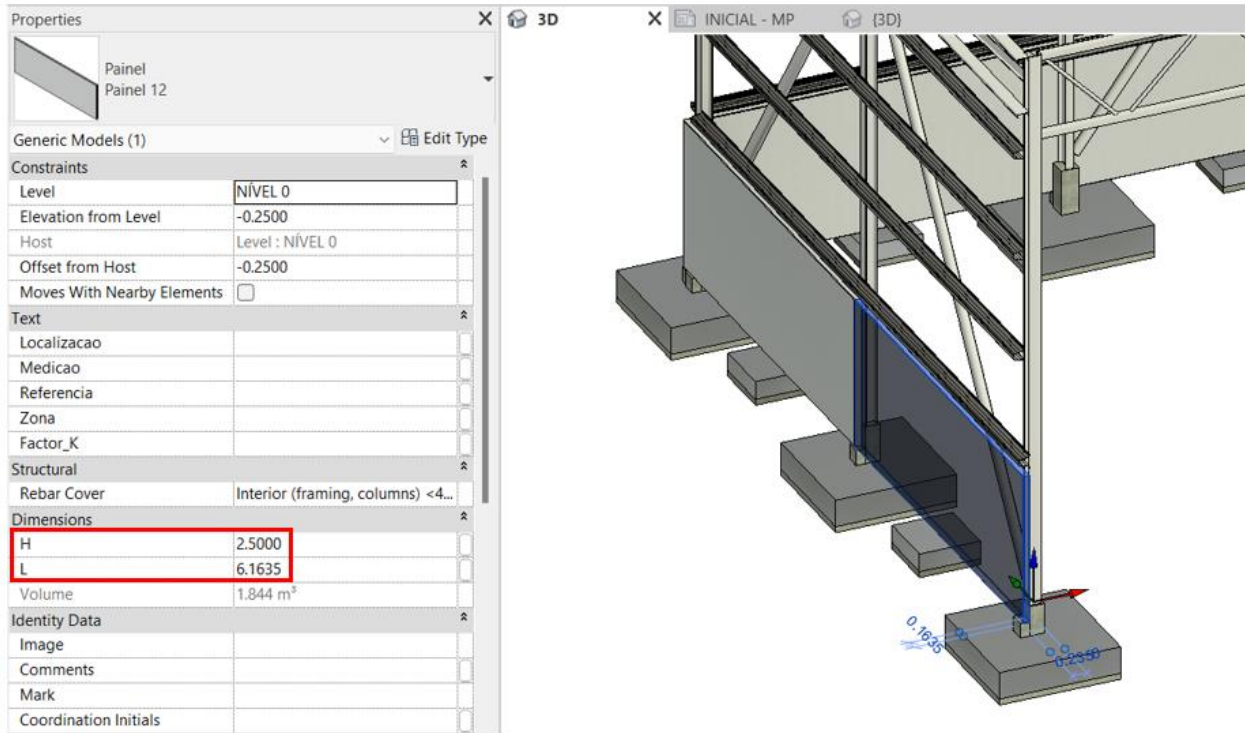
Parâmetros do painel pré-fabricado em betão
